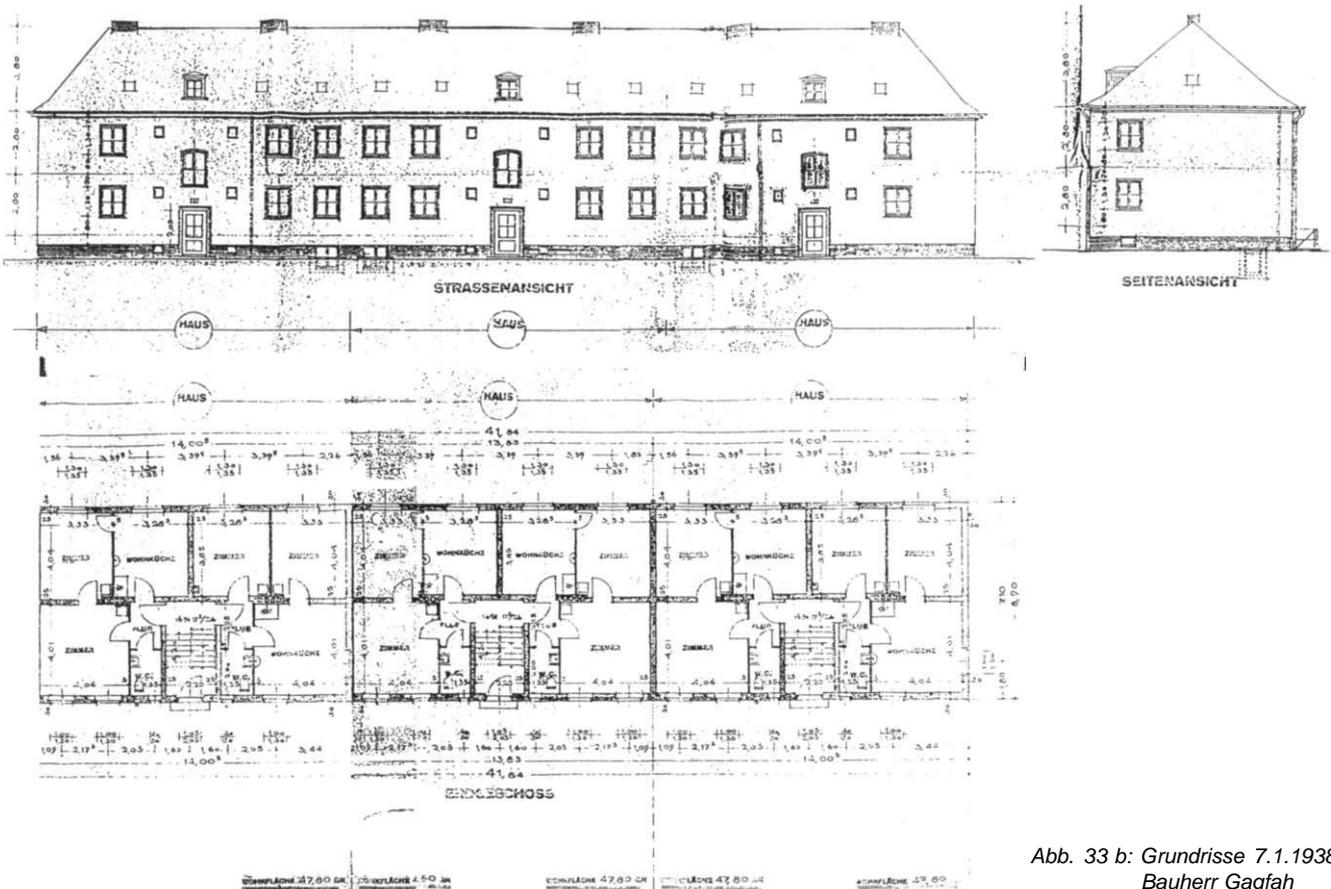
b: Grundrisse 7.1.1938, Bauherr Gagfah
